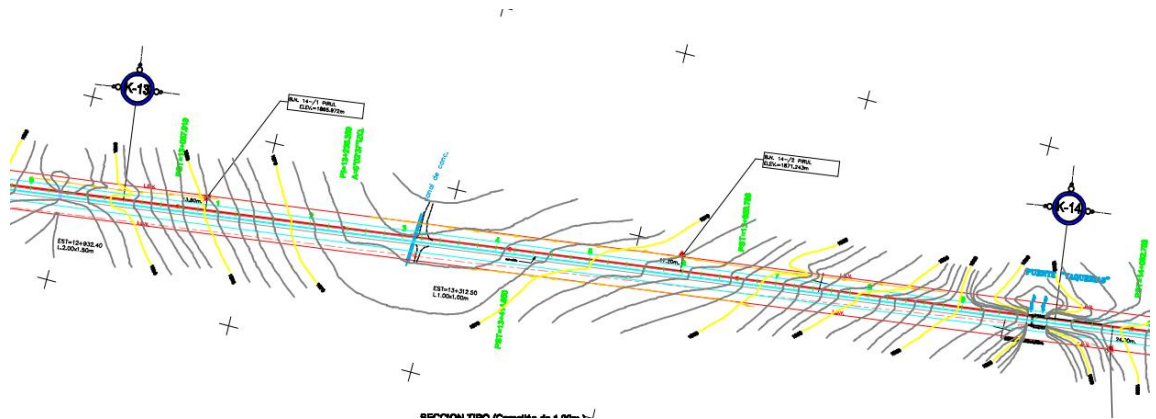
Planta del proyecto km 13 al 14. (SCT, 2008).
